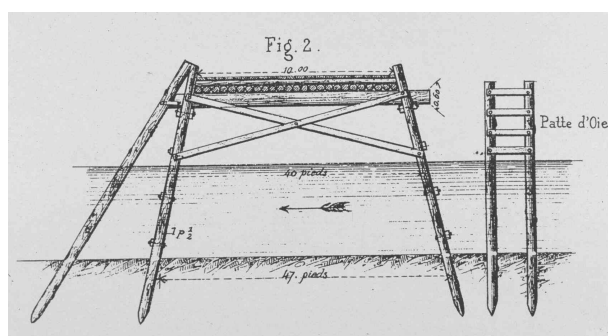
Fondations sur pieux du pont sur le Rhin (Reiffsteck, 2009)
